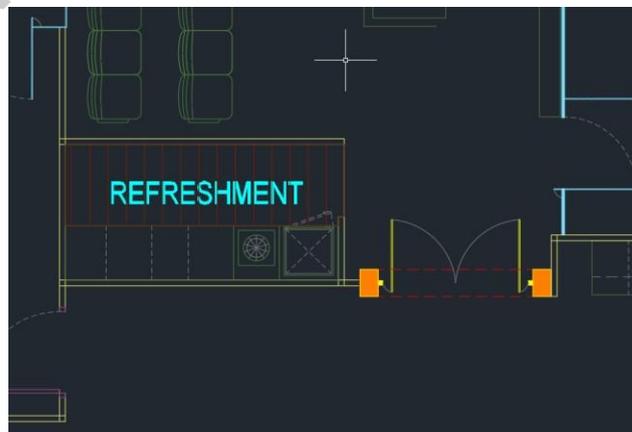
Progres rencana layout interior Rajawali Place
